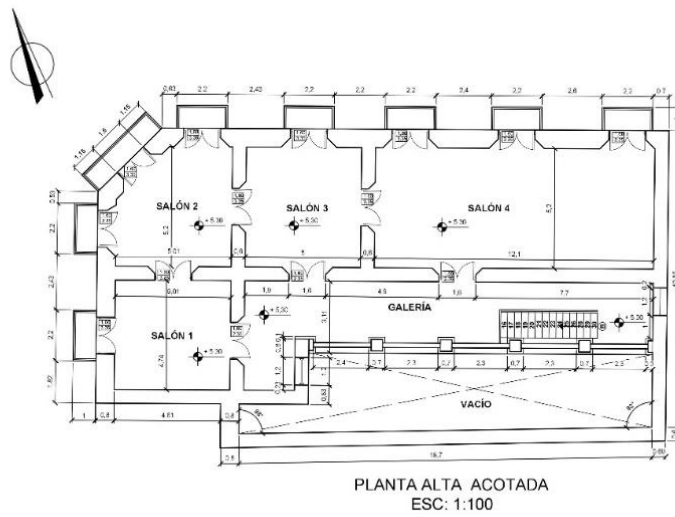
Planta Alta Acotada, Relevamiento Métrico.
